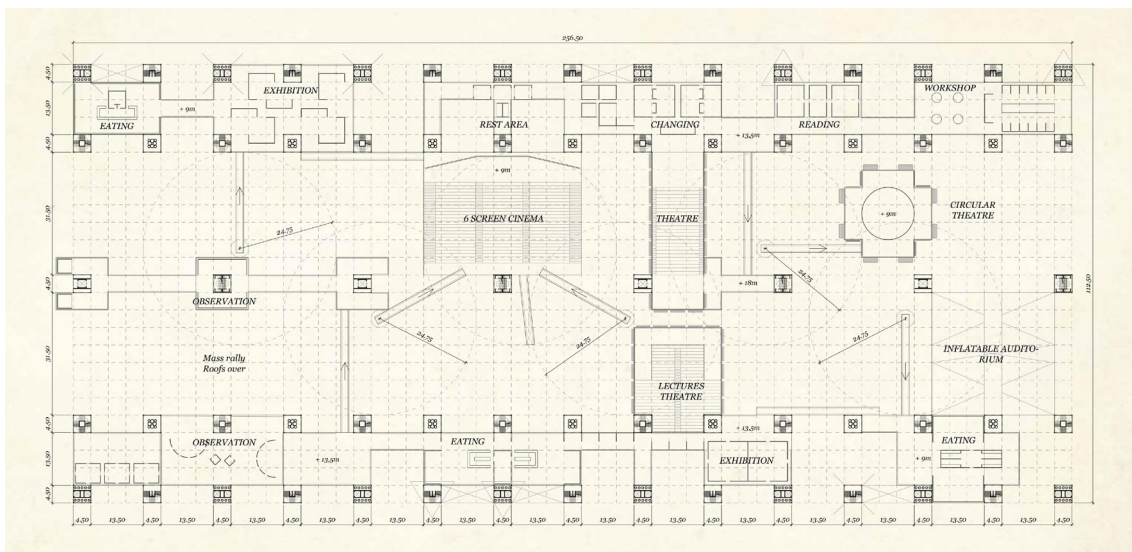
Una posible configuración del Fun Palace, proyección en planta. Elaboración propia
